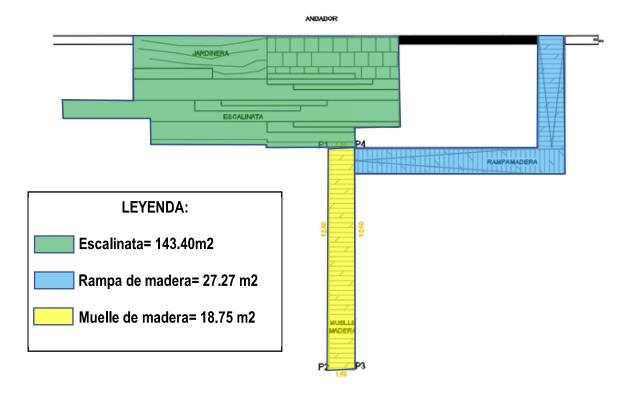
Planta de conjunto del proyecto con delimitación de obras.
